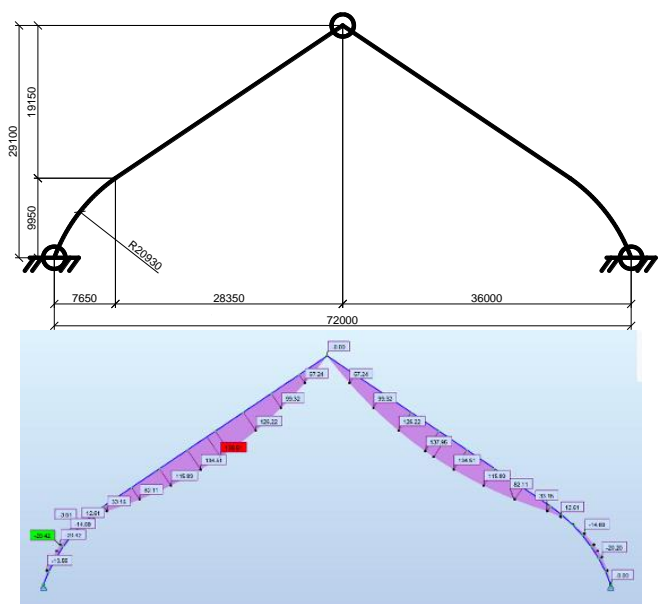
Арка тип 2 – нижний гнутый карниз и прямолинейный до конька
